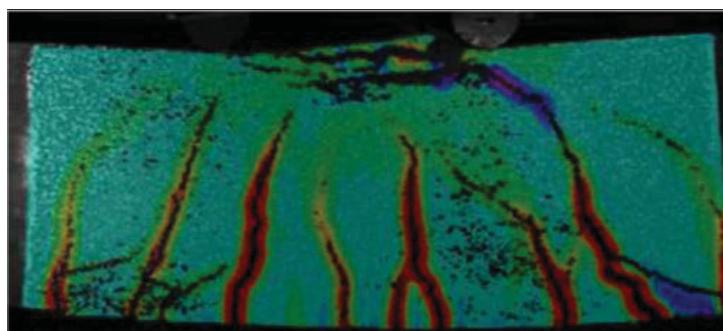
PADRÃO DE FISSURAÇÃO UTILIZANDO DIC
